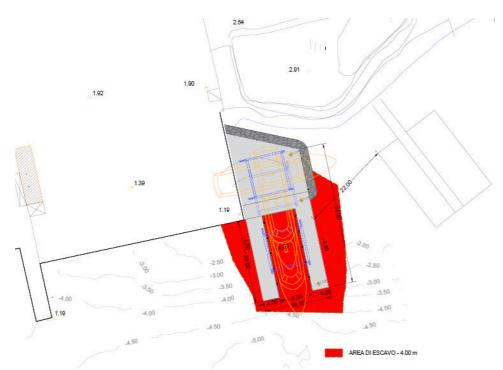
Pianta della proposta progettuale e indicazione dell'area di dragaggio
